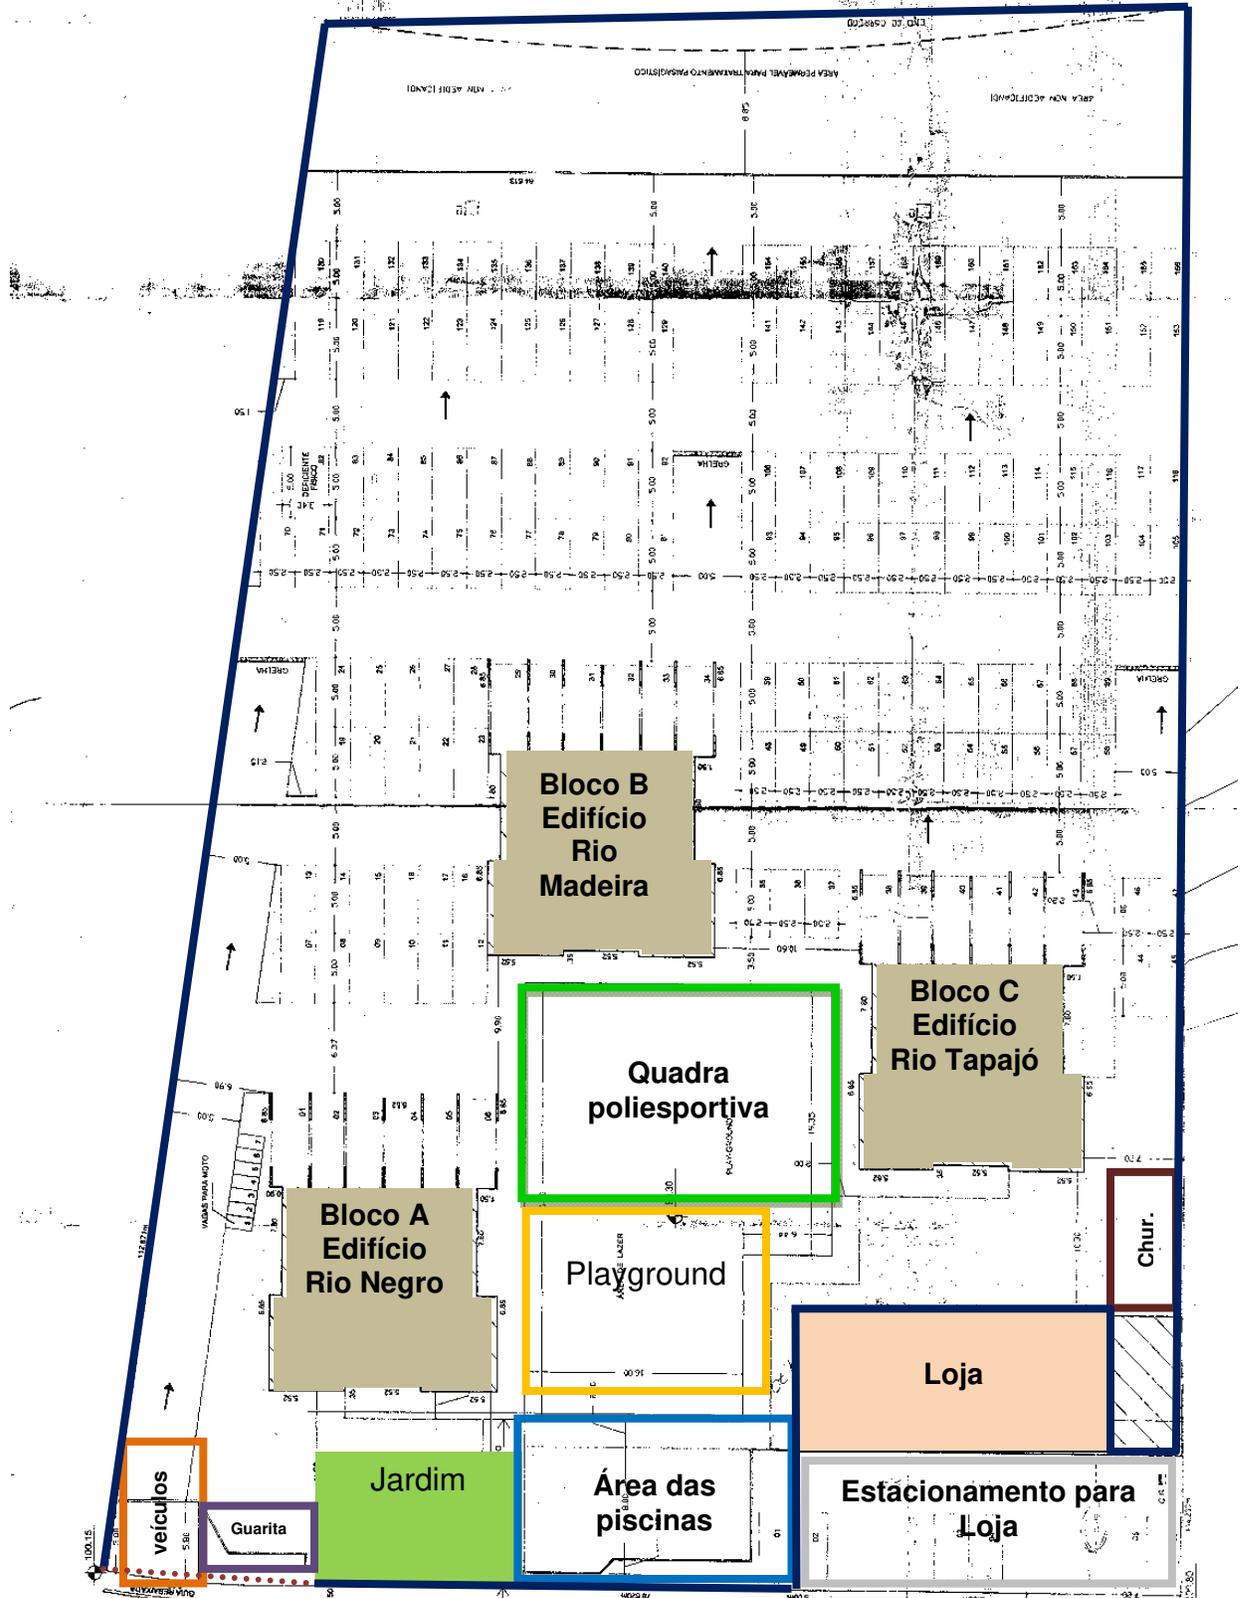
Implantação do Condomínio Bom Clima. Fonte: a partir da planta de implantação.
